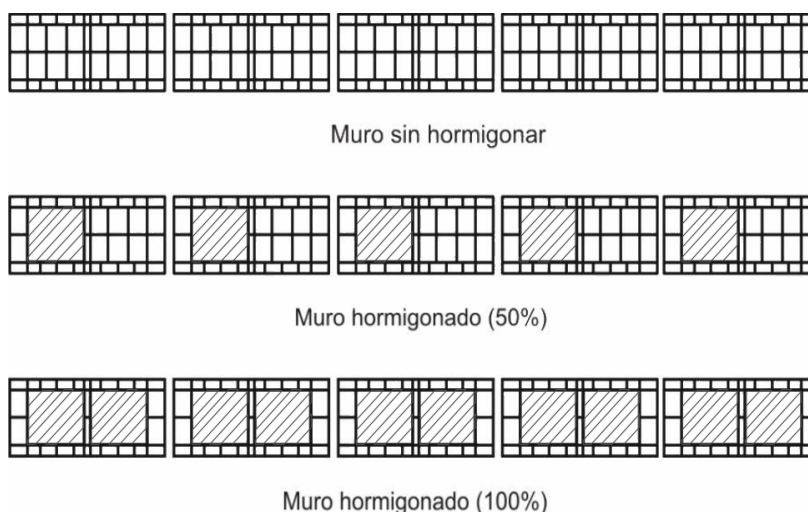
Muros de mampostería de bloques huecos hormigonados y no hormigonados
